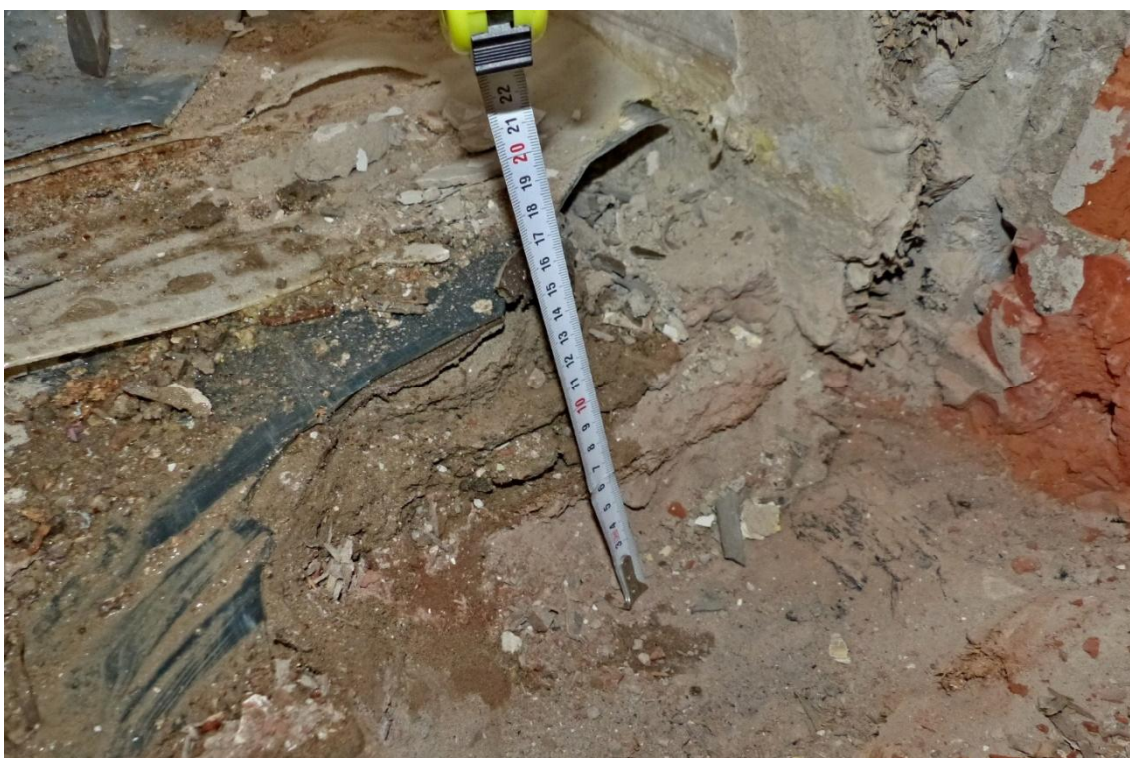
Detailní pohled na sondu P3a u obvodové zdi nad kanálem s vytápěním
